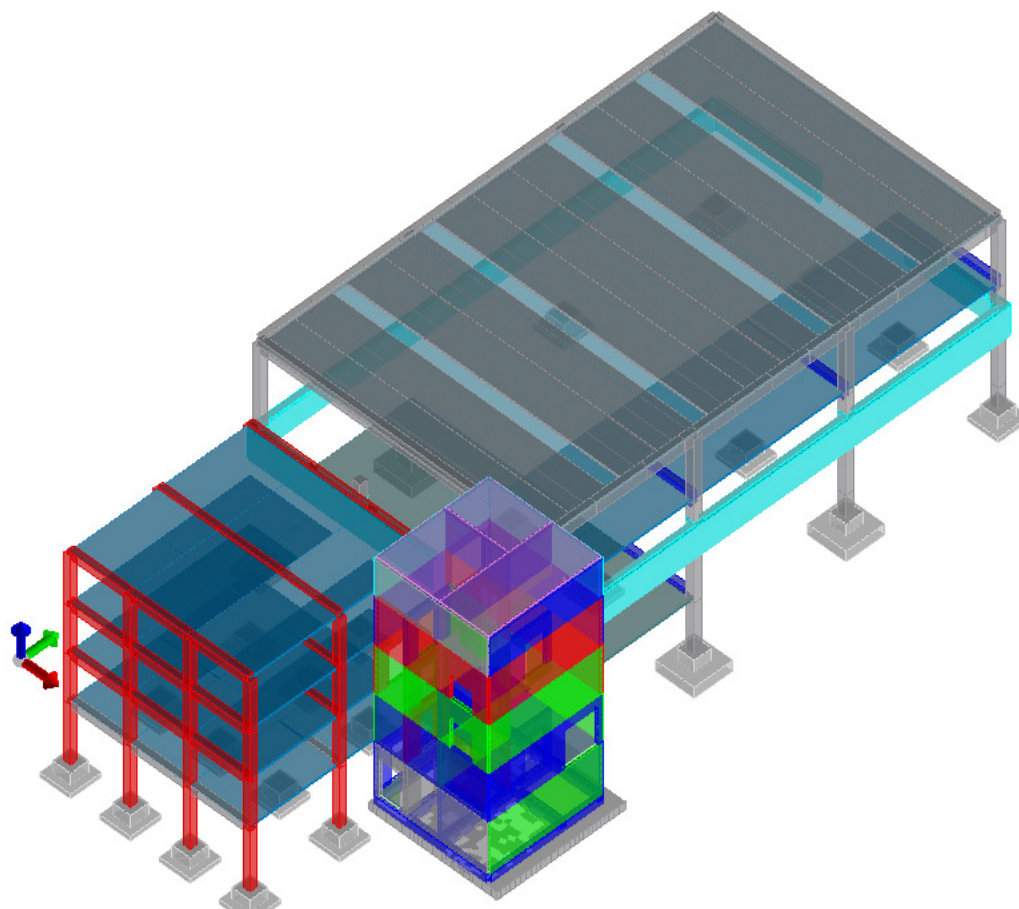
Vista degli elementi strutturali, prospetto SUD-OVEST - Modello FEM
